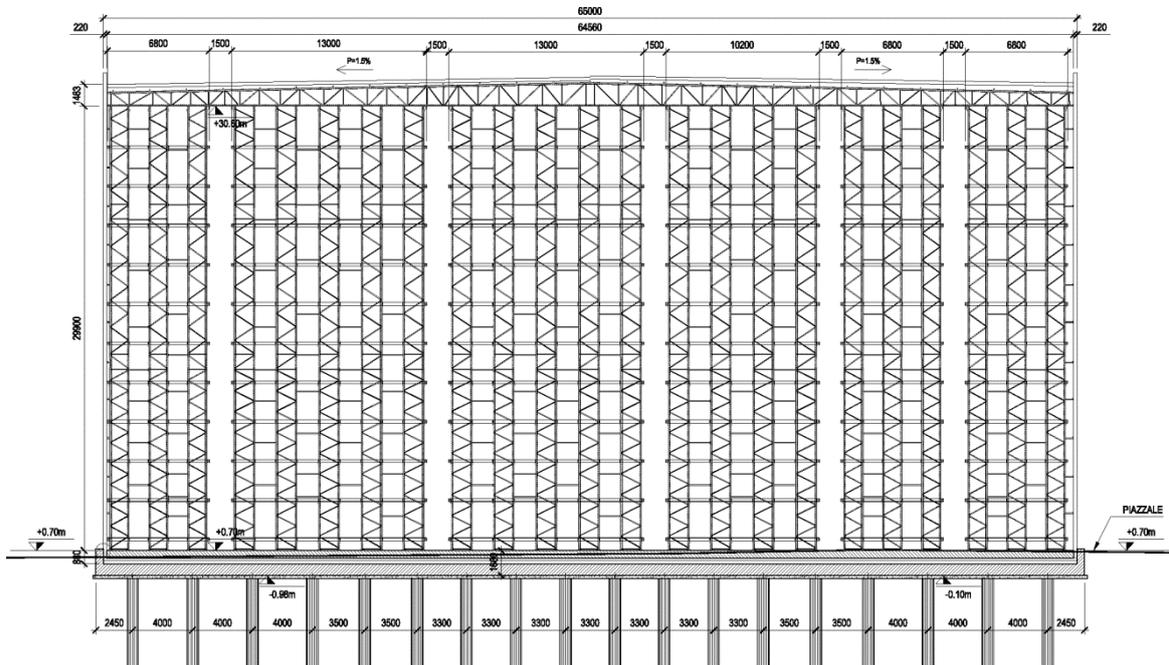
Sezione trasversale tipo struttura di elevazione
